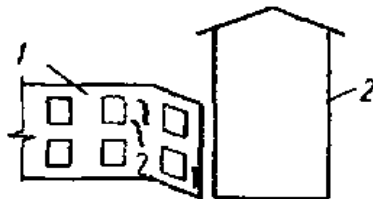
Перекос здания в результате развития дополнительной осадки уплотнения:
